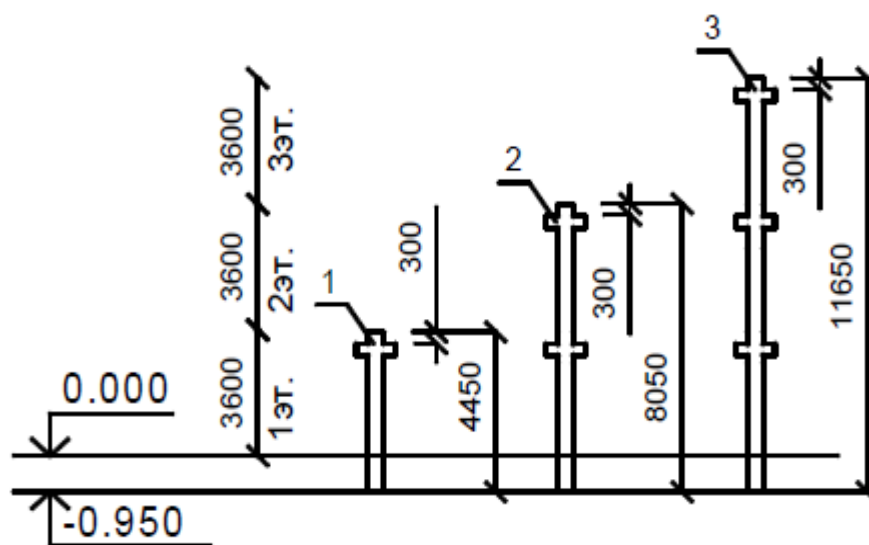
Колонны каркаса сечением 300х300 мм для зданий без подвала с высотой этажей 3600 мм
